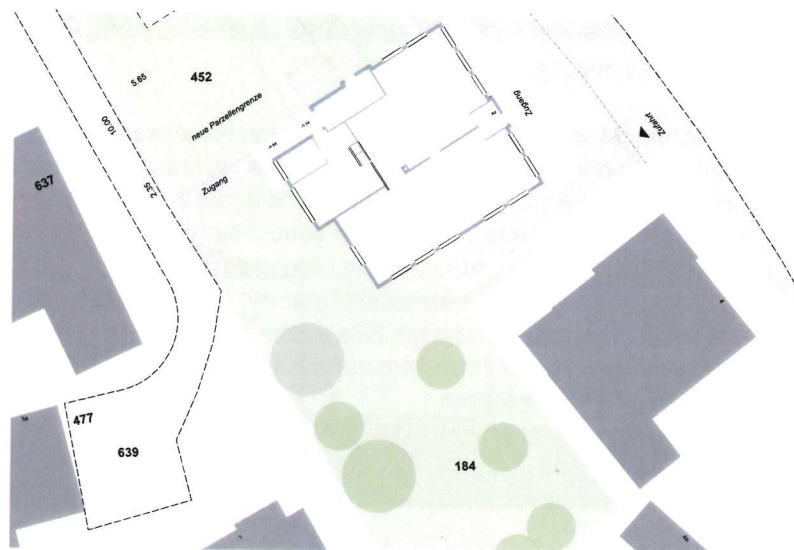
Richtprojekt Februar 2017: Einstellhalle mit Abstand zur Parzelle Nr. 384
